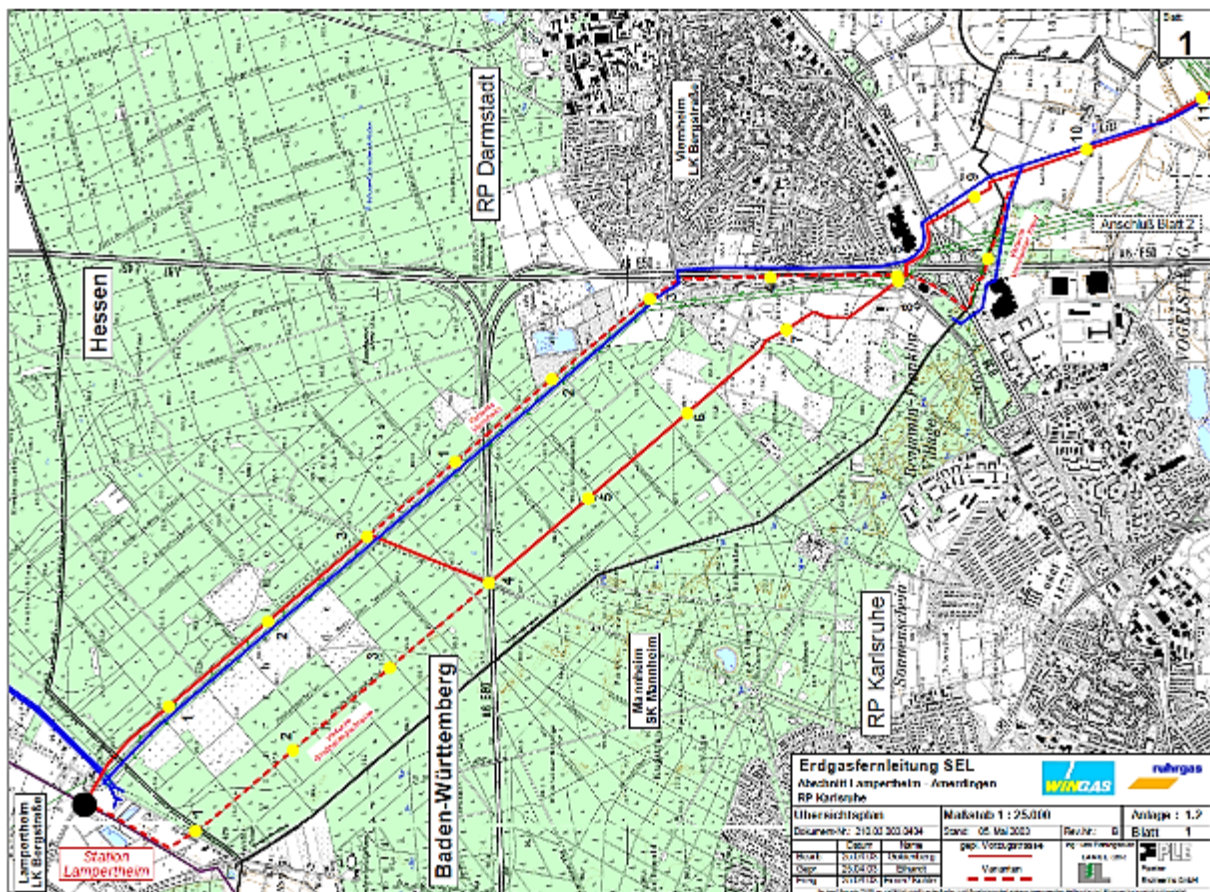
Lageplan Variante Viernheimer Kreuz (Quelle: ROV)
